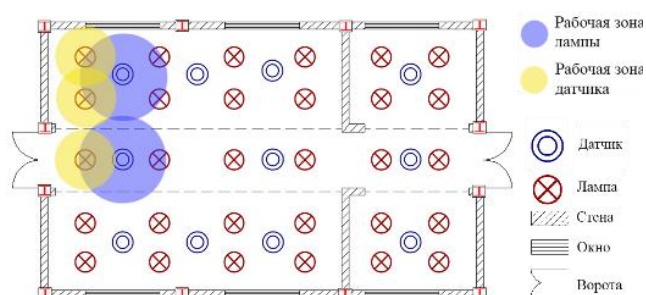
Схема участка механосборочного цеха с рабочими зонами ламп и датчиков
